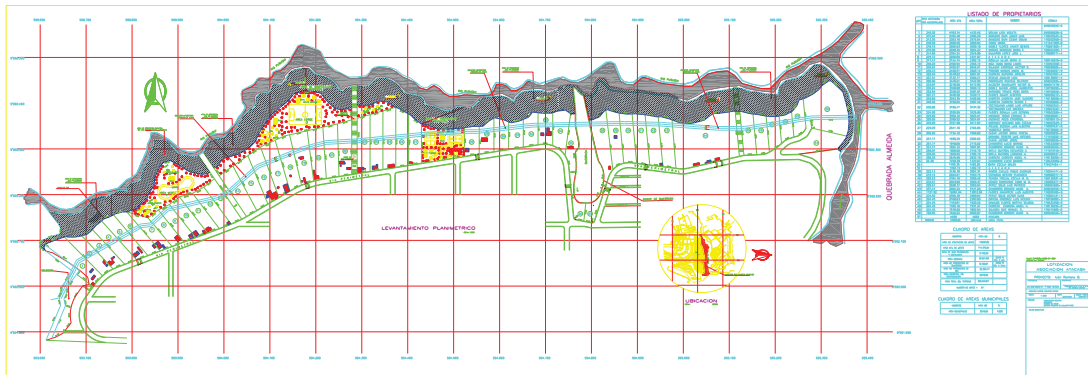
Levantamiento Planimétrico del Barrio Atacaba. Fuente: (Levantamiento Planimétrico - Arq. Iván Romero, 2017)
